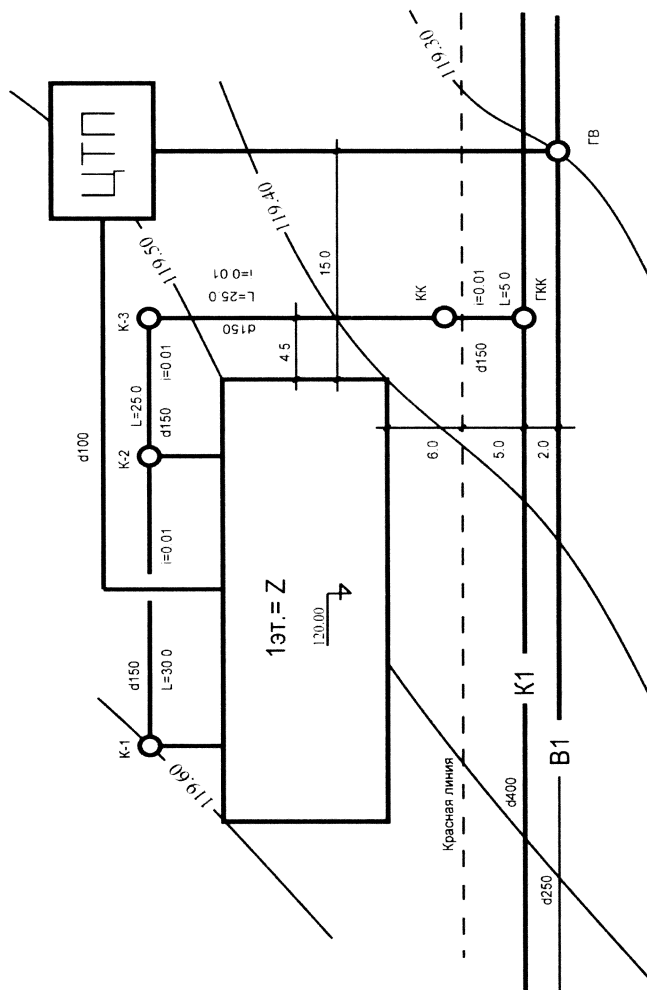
Генплан участка застройки жилого здания с сетями водопровода и канализации.
